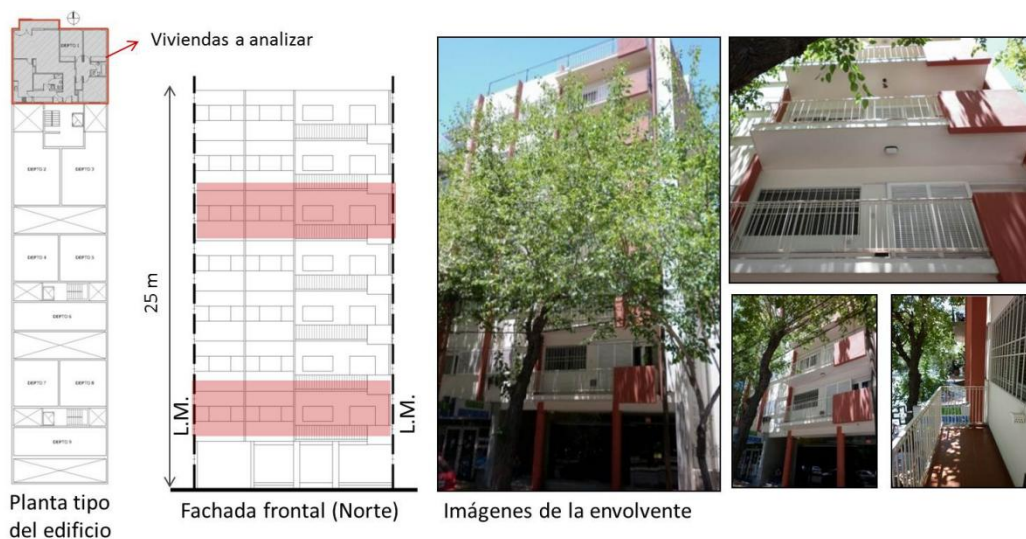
Planta tipo, fachada frontal e imágenes del edificio monitoreado. Fuente: Elaboración propia; 2015.
